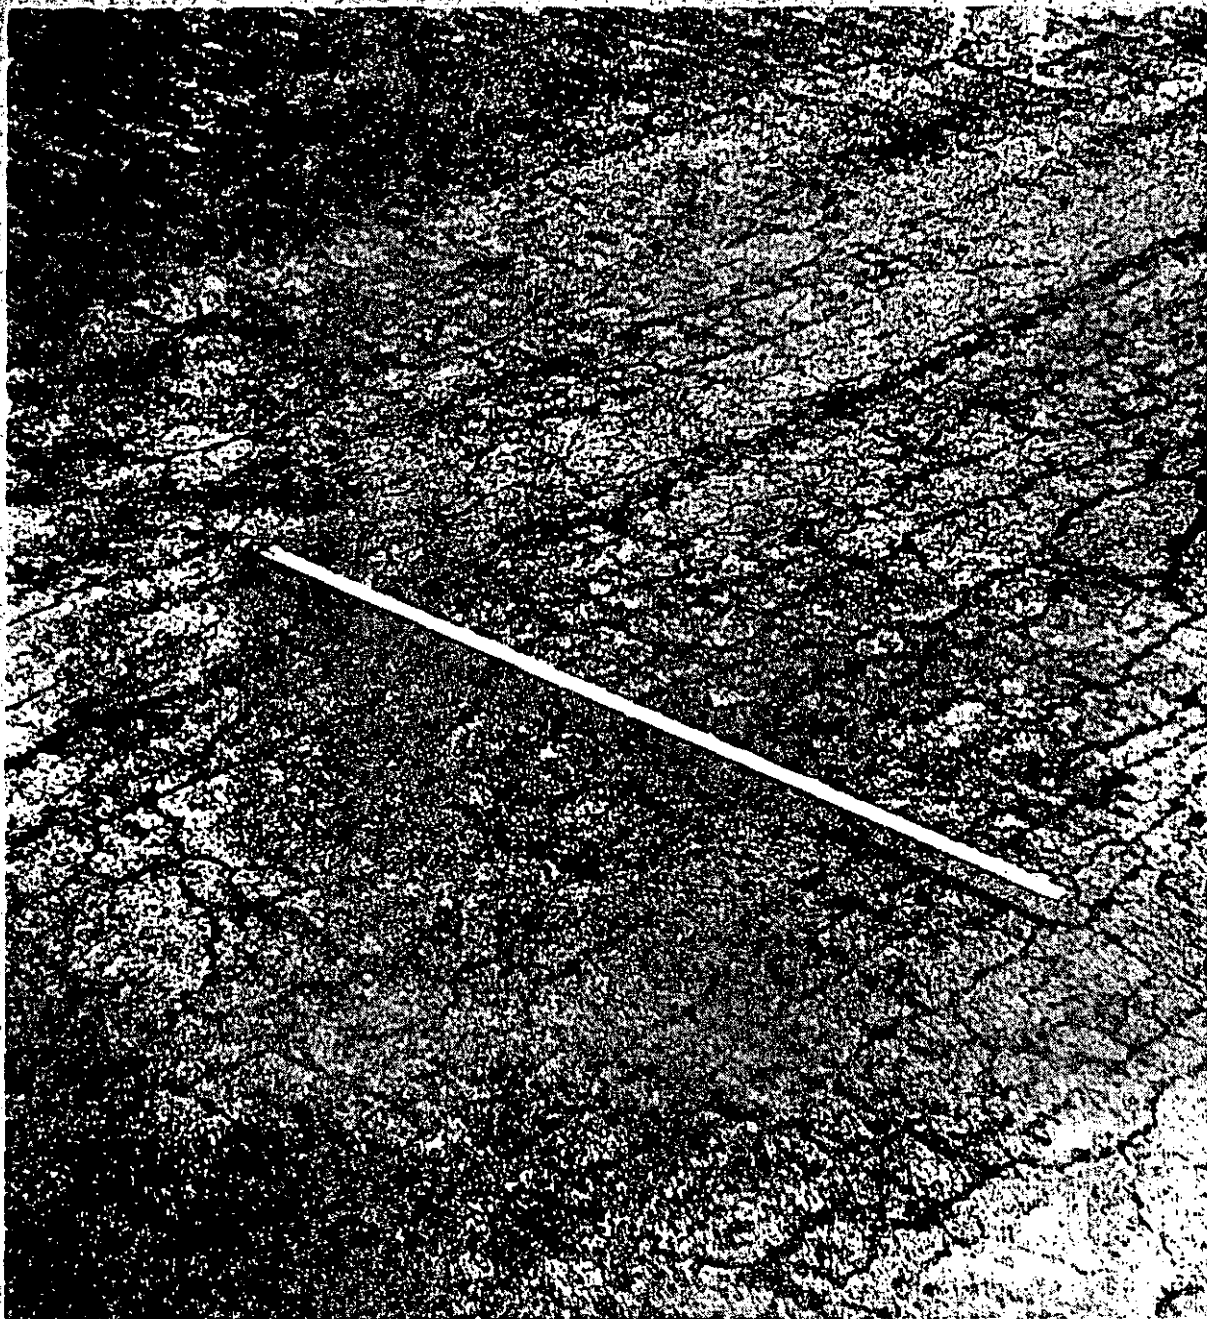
Asentamientos y grietas en forma de piel de cocodrilo, en la faja de rodamiento de una calle de rodaje
